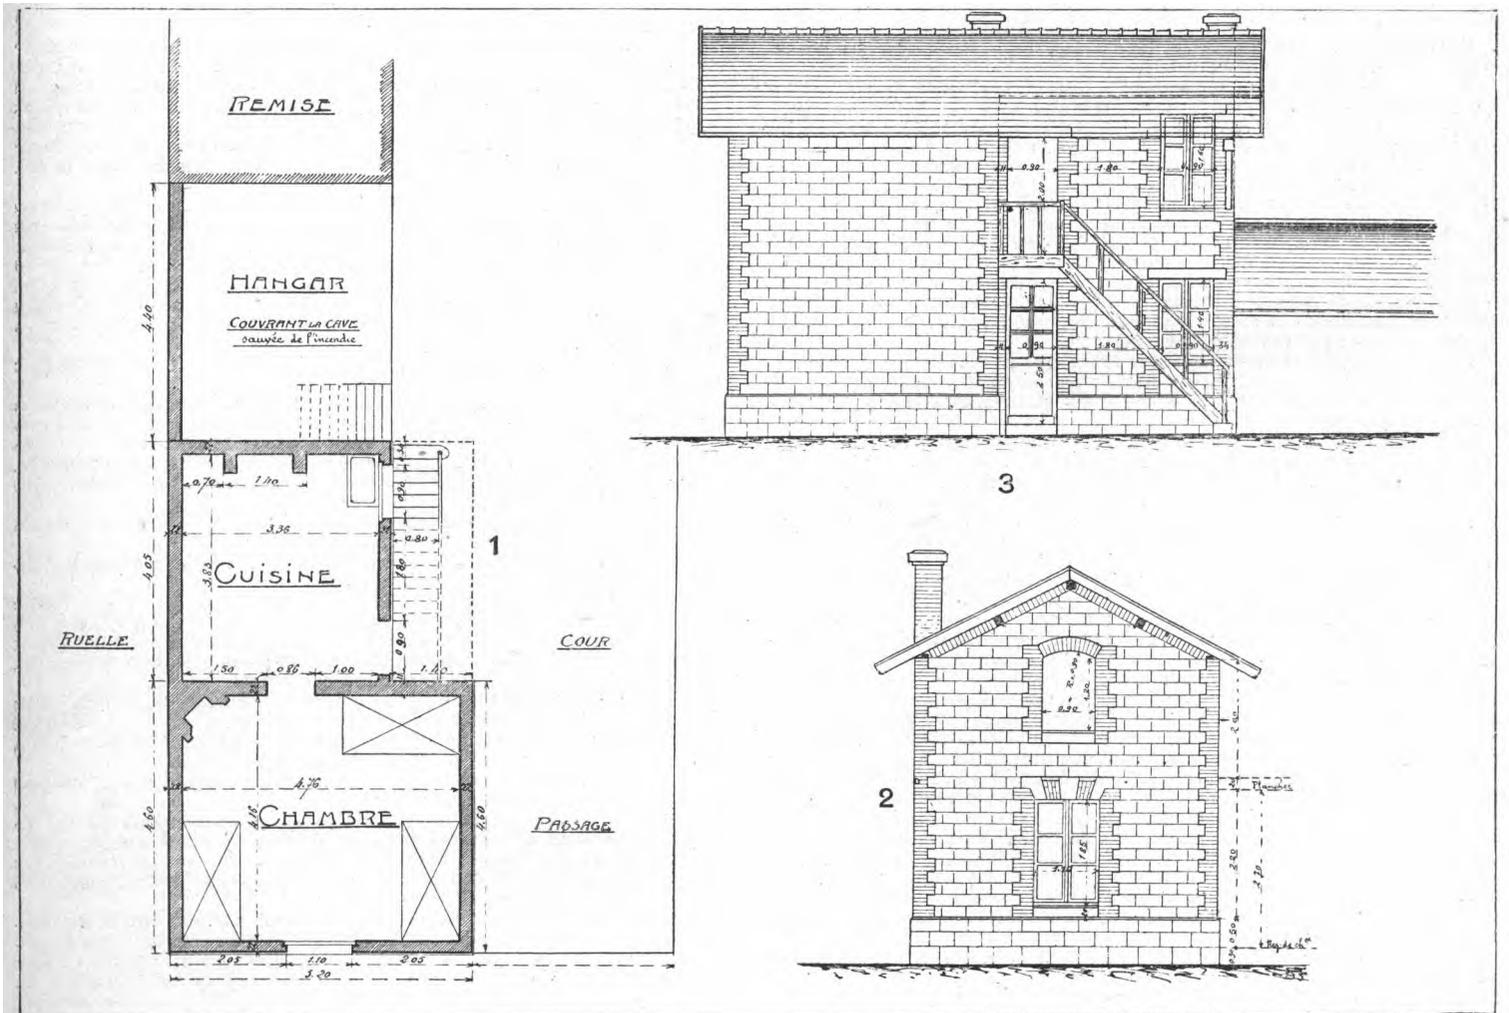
Type d'habitation pour ouvriers agricoles. 1. Plan du rez-de-chaussée; 2. Façade sur rue; 3. Façade principale.
